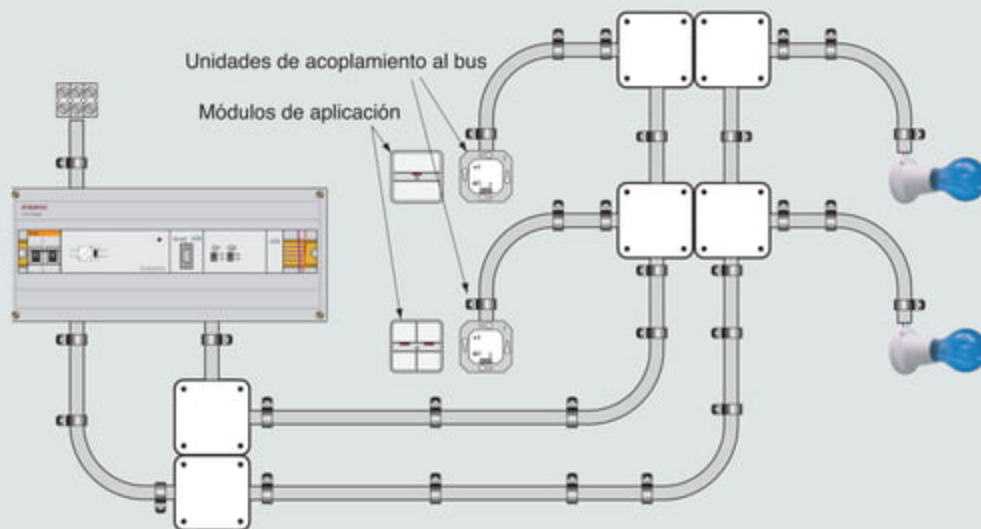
Conjunto completamente montado excepto los módulos de aplicación para caja universal.
